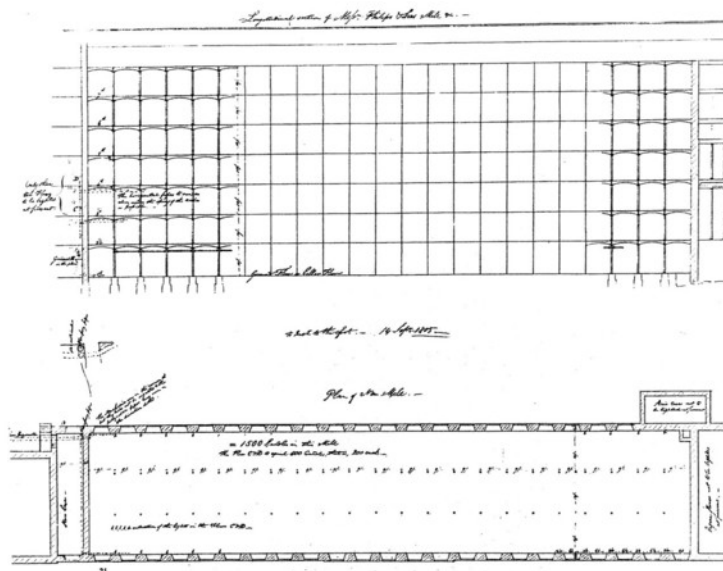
Salford Twist Mill, Grundriss der Tuchfabrik von Philips und Lee, erbaut 1802
